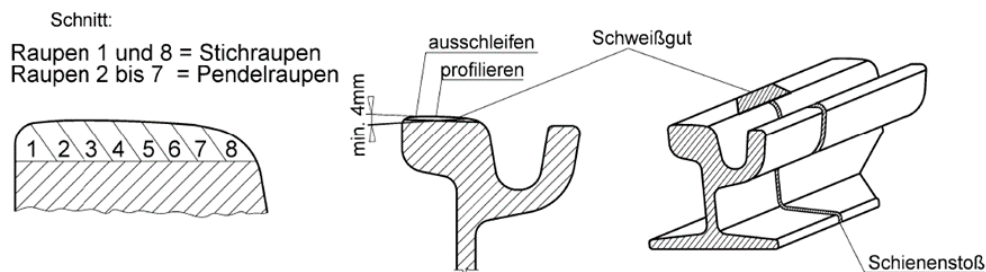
Beseitigung Fahrflächenfehler durch Auftragschweißen
